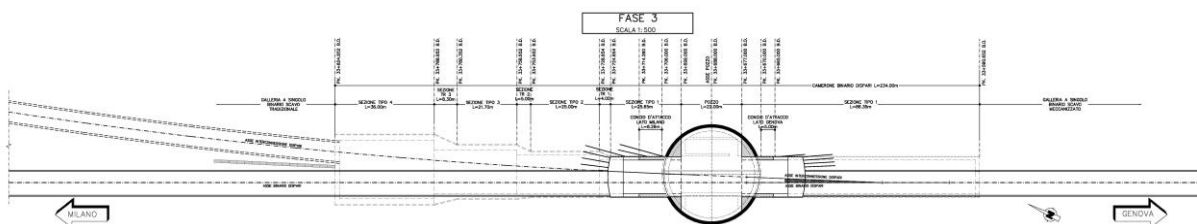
Avanzamento piena sezione lato Genova e Milano
